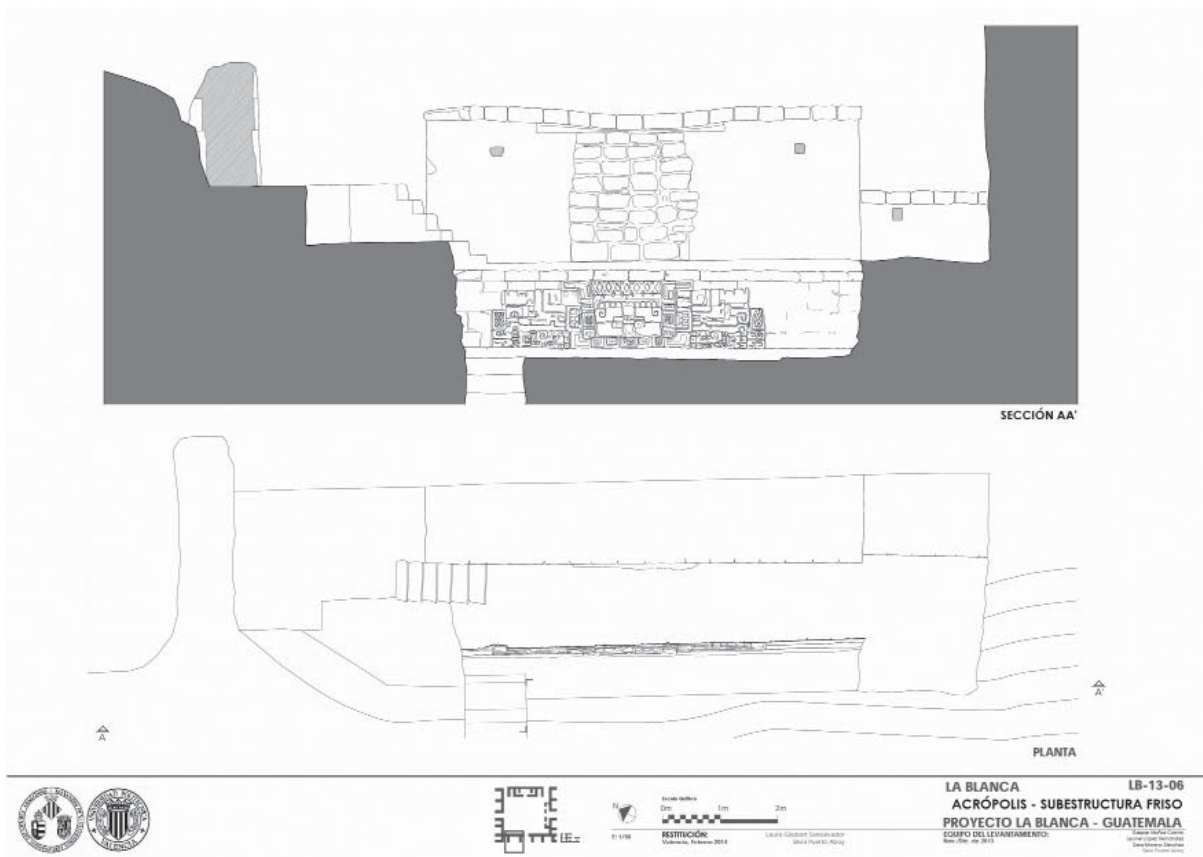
Planta y alzado de la fachada oeste de la Subestructura 6J2-Sub. 2 de la Acrópolis de La Blanca. (PLB 2013).
